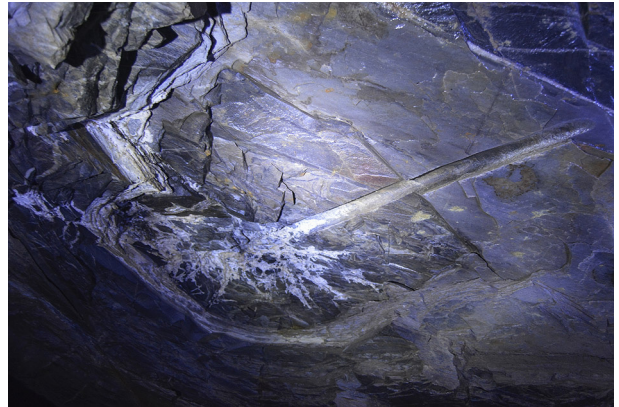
Huella de barreno en el techo de la galería. Autoría Propia.
